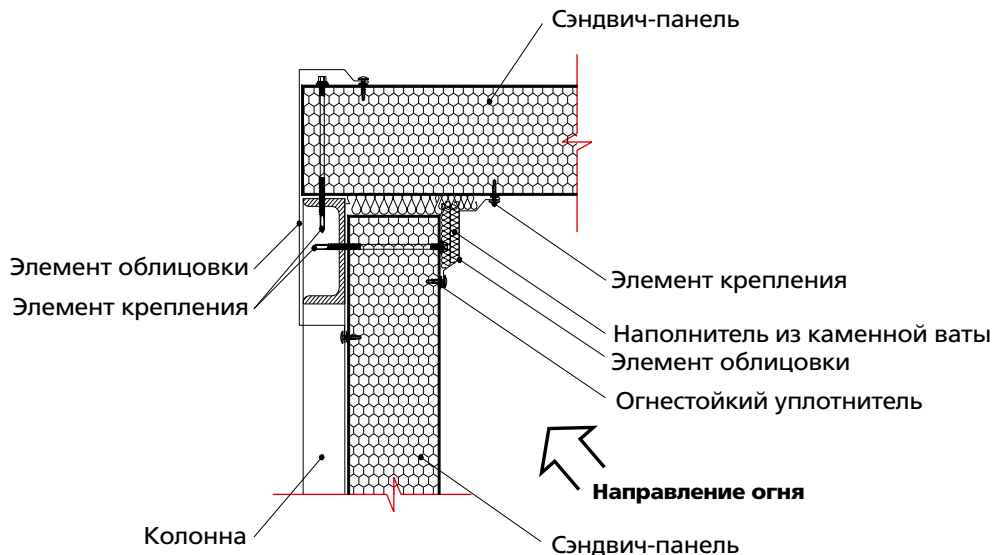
Огнестойкое крепление стеновых панелей и кровельных панелей
